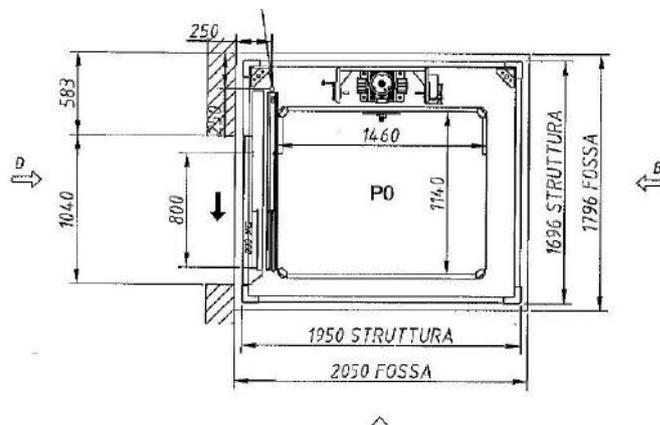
18 – Impianto di Elevazione TIPO e Pianta schematica
